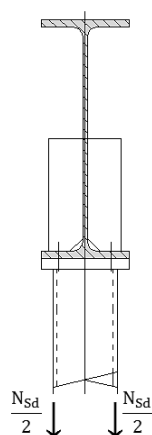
Secção transversal da viga com dois reforços transversais parciais
